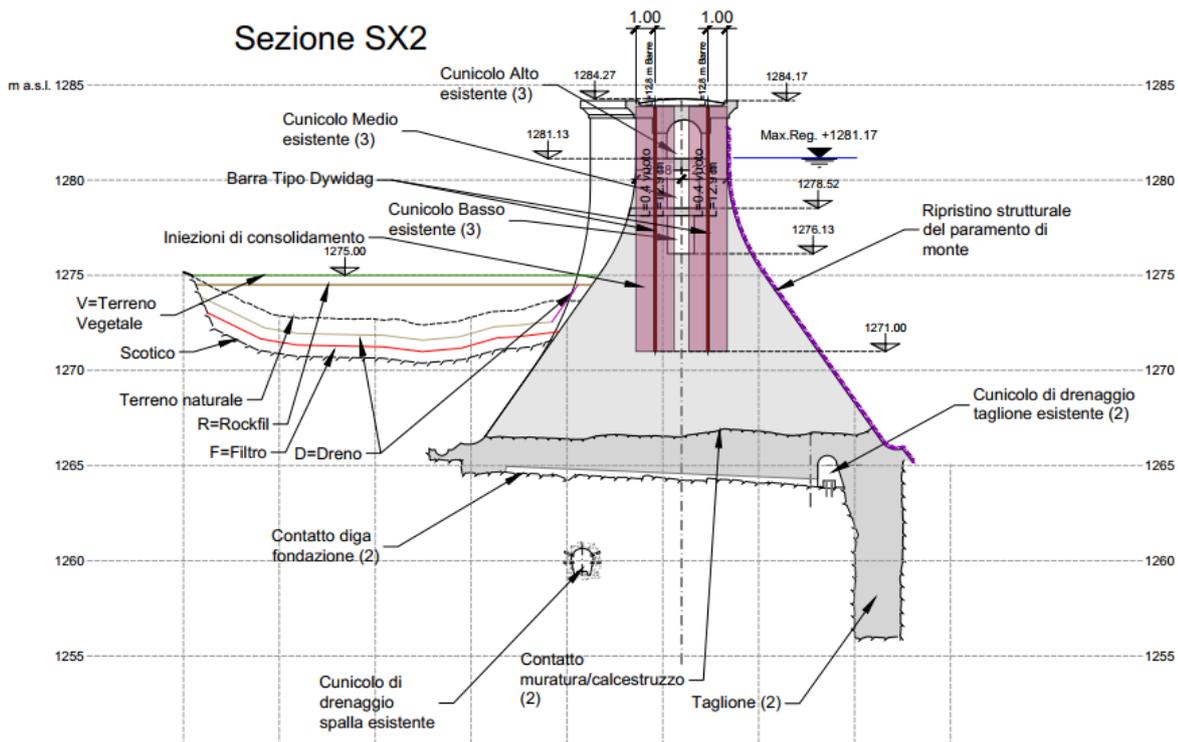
iniezioni dal coronamento dello sbarramento secondario, sezione trasversale
